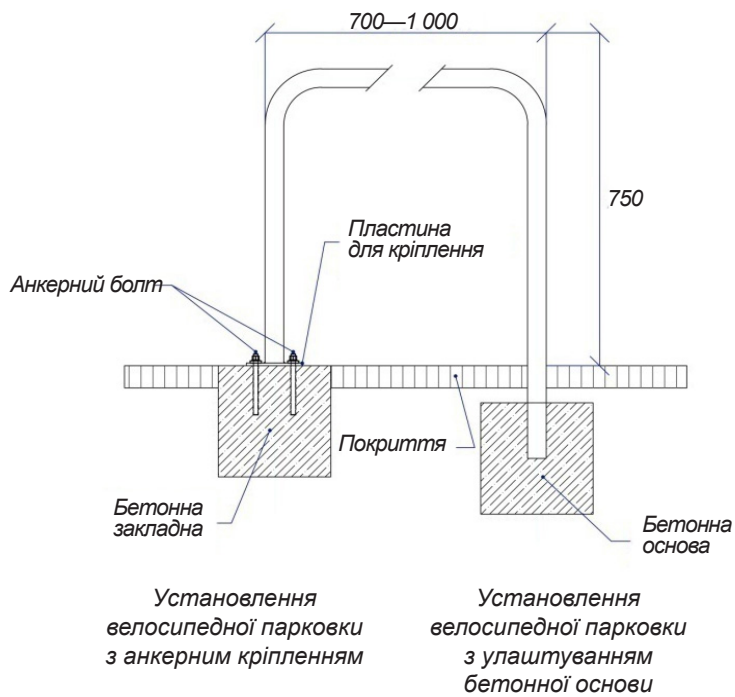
Рекомендовані розміри стійки велосипедної парковки з установленням її на анкерних болтах чи бетонних фундаментах
